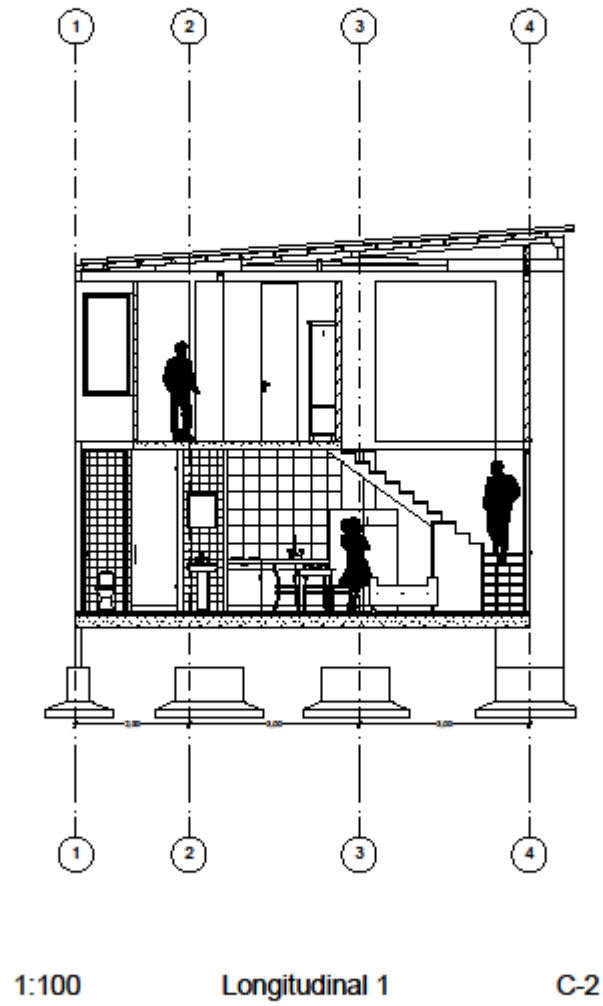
Tipo A. Corte Fachada. Esc.: 1:100
